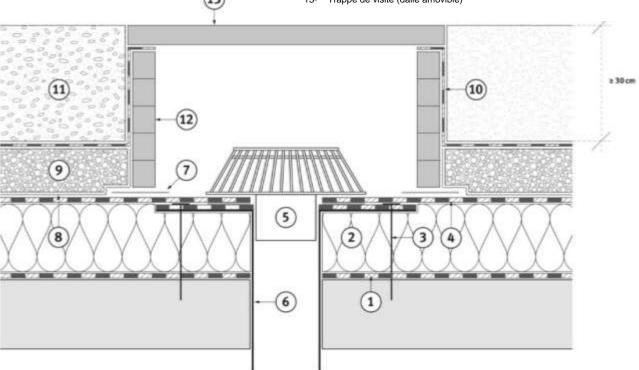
Entrée d'eau pluviale pour toiture-terrasse Jardin
